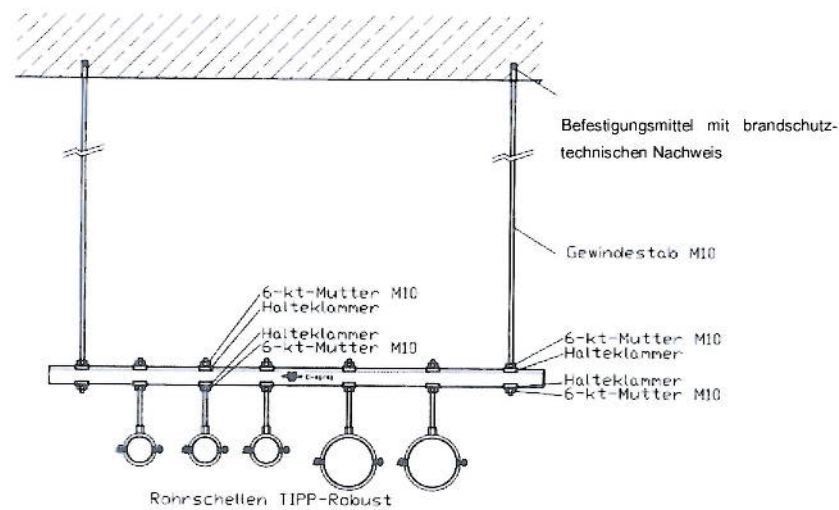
Schematische Darstellung abgehängt montierter Würth Varifix® C-Montageschiene, befestigt mit Gewindestangen und Muttern, Schrauben oder Dübeln der Dimension \geq M10 (Festigkeitsklasse \geq 4.6) mit brandschutztechnischem Nachweis in Verbindung mit Würth Halteklammern, mit unterseitig montierten Installationen
